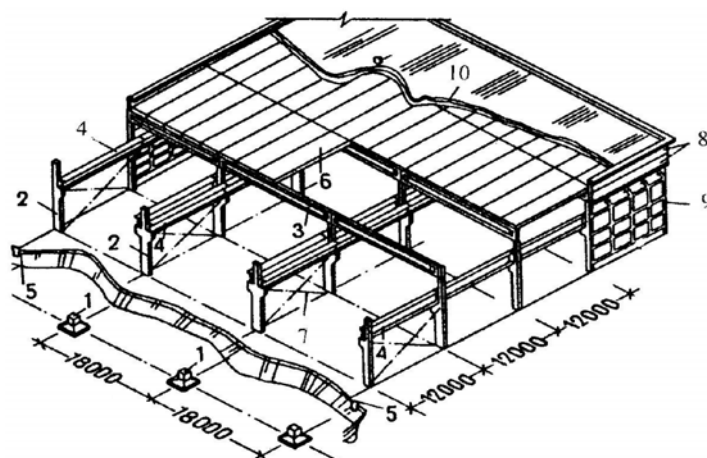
Основні конструктивні елементи каркасної одноповерхової промислової будівлі: 1 – фундамент; 2 – колона; 3 – балка покриття; 4 – підкранова балка; 5 – фундаментна балка; 6 – плити покриття; 7 – сталеві зв'язки між колонами; 8 – зовнішні стіни; 9 – вікно; 10 – огорожувальні шари покриття
